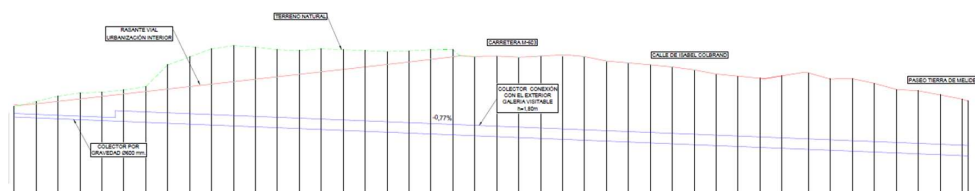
Esquema del perfil longitudinal de la conexión con la red municipal. alternativa por gravedad
